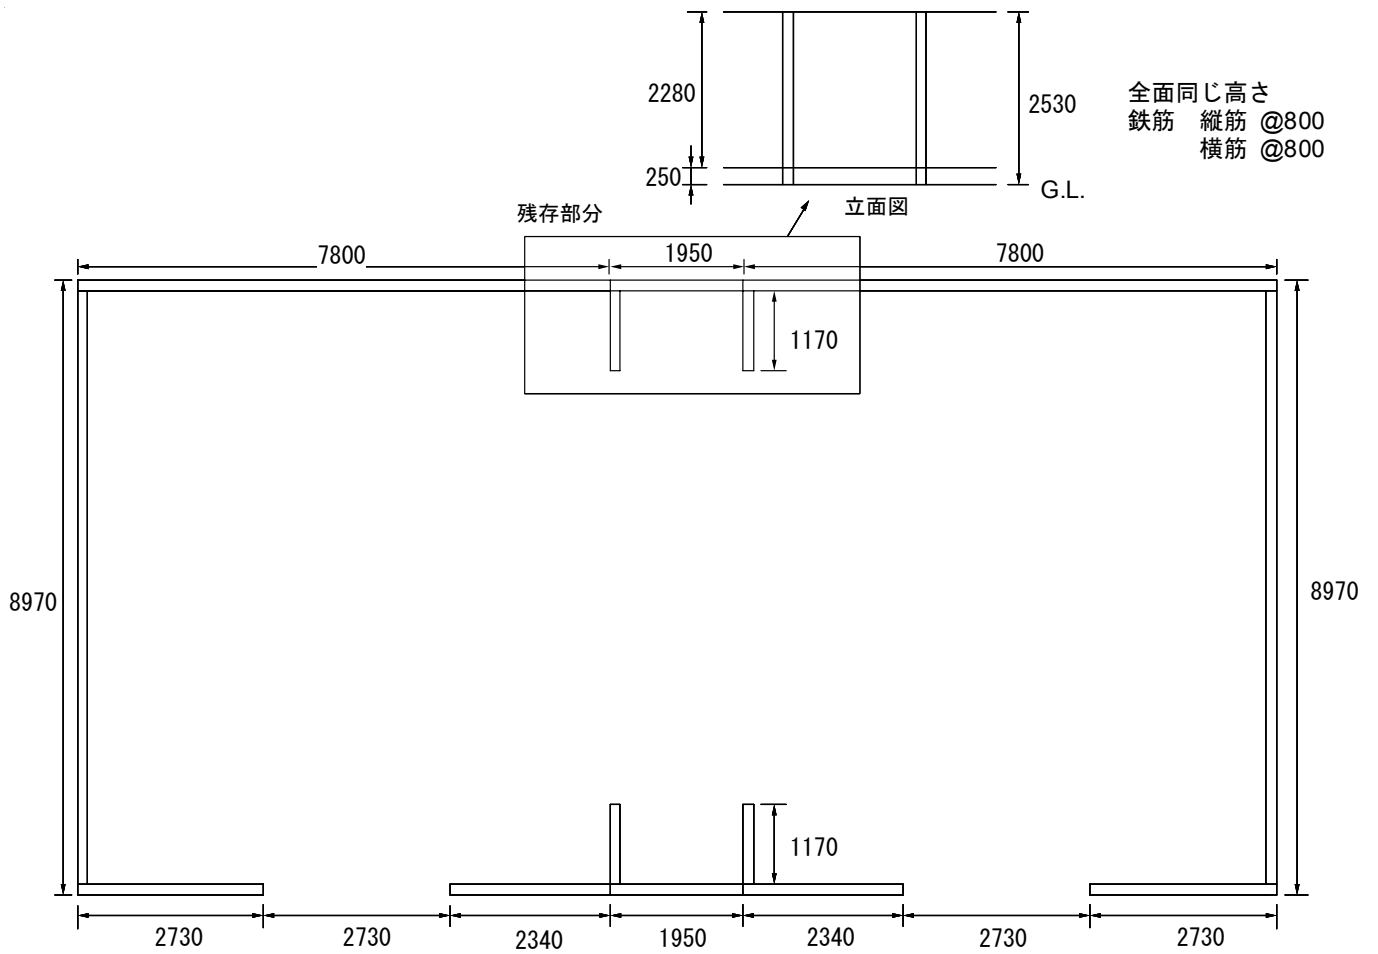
CB 造倉庫平面図・立面図 (単位 : mm)
